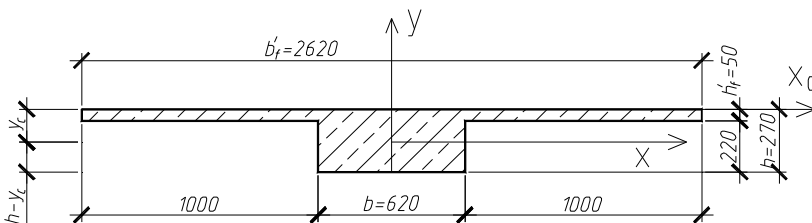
Расчетная схема поперечного сечения монолитного ригеля
